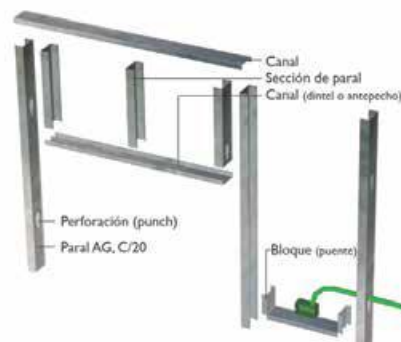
Detalle para la colocación de instalaciones eléctricas y sanitarias
